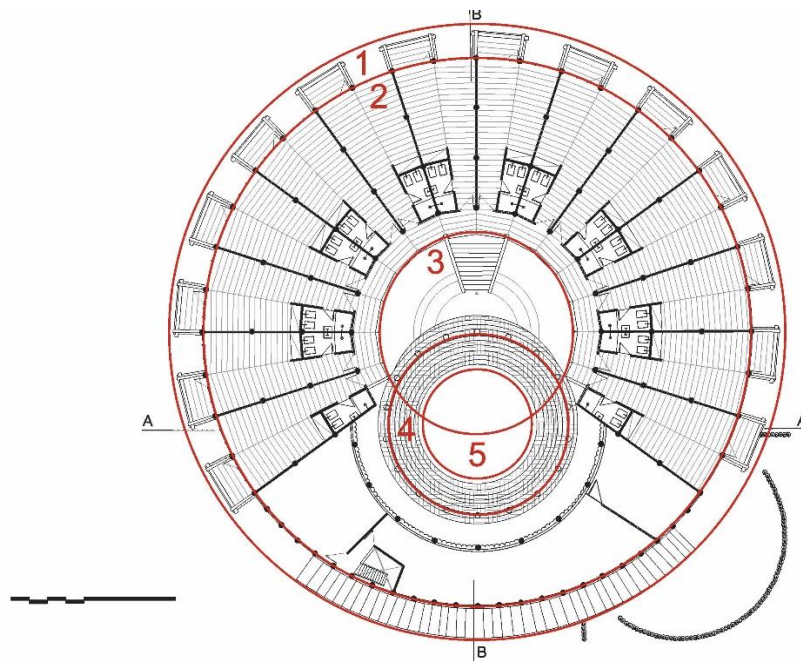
Princípios geométricos em planta baixa – pavimento superior da nave principal. Fonte: acervo pessoal.
